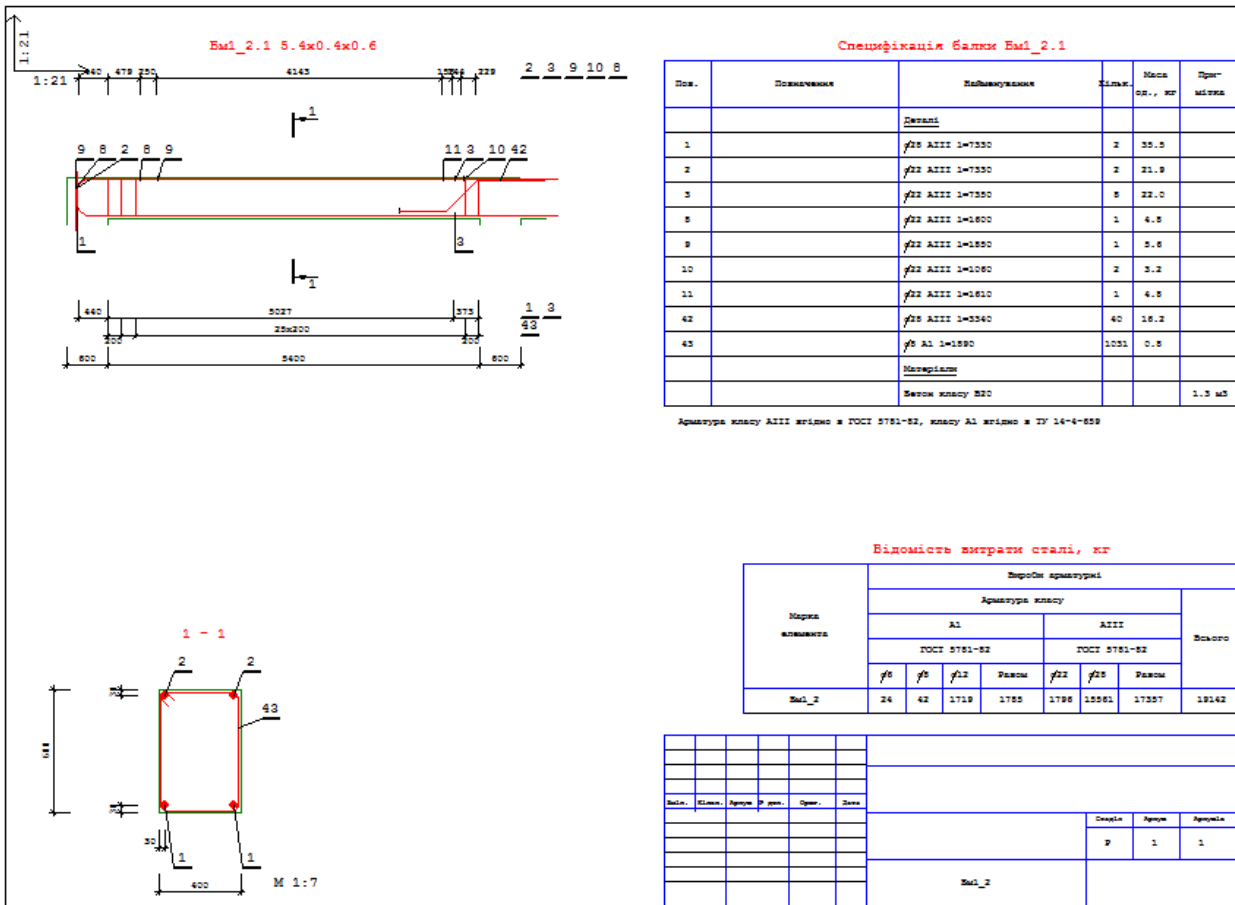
Варіант будівлі з балочно - плитним перекриттям. Балка Б4-2. Креслення робочого проекту.
